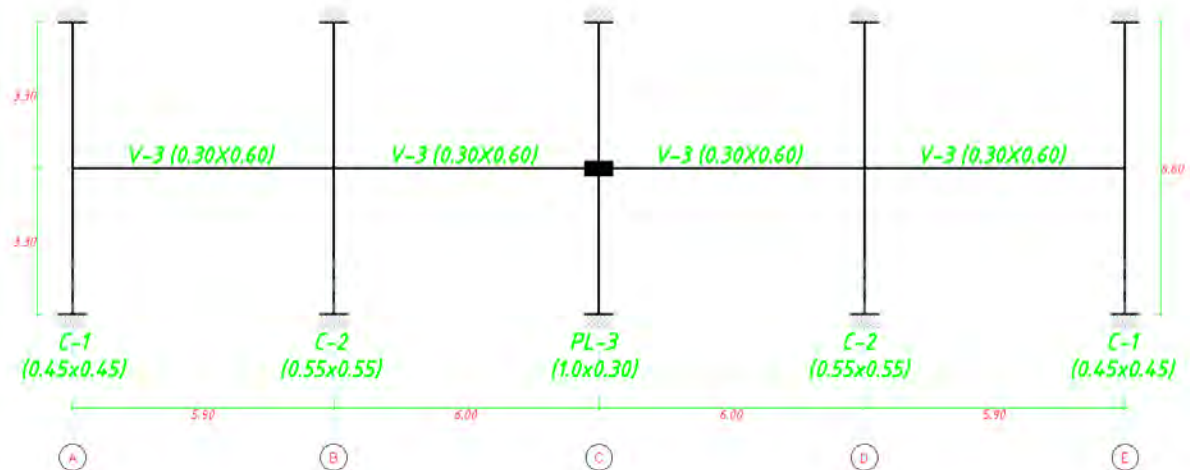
Modelo estructural de viga según NTE para cargas de gravedad.
